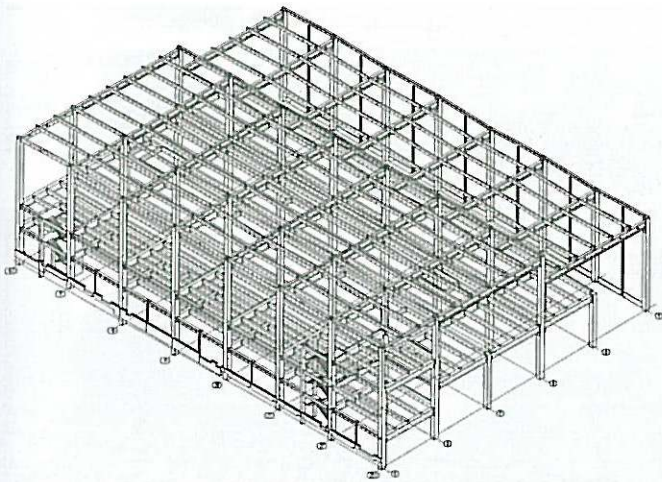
Räumliches Modell der Fertigteilkonstruktion im dritten Bauabschnitt
